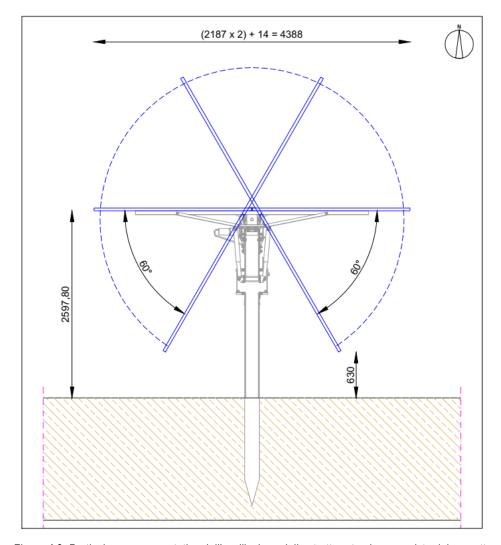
Particolare rappresentativo dell'oscillazione delle strutture trackers previste dal progetto
